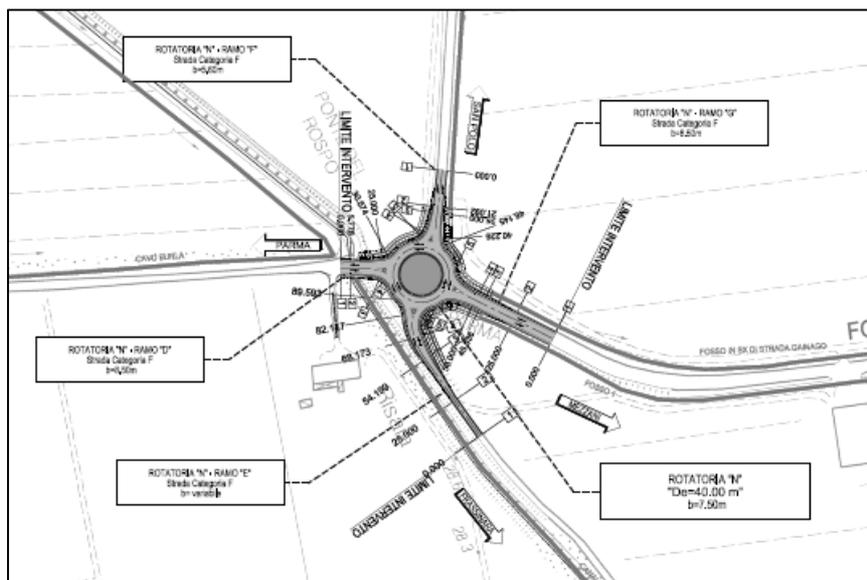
Planimetria di Progetto – Tratto B - Opera 1PR
